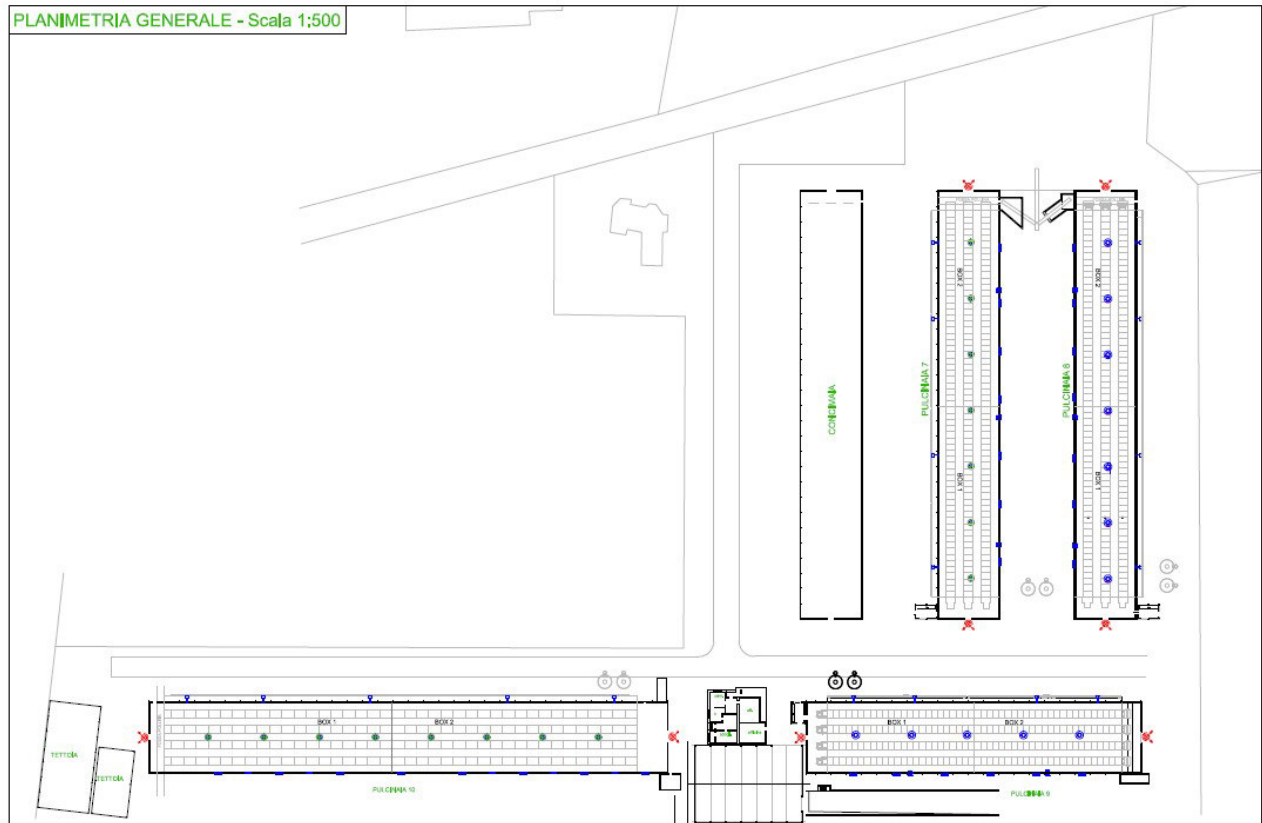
Planimetria dello stabilimento in configurazione di progetto.
